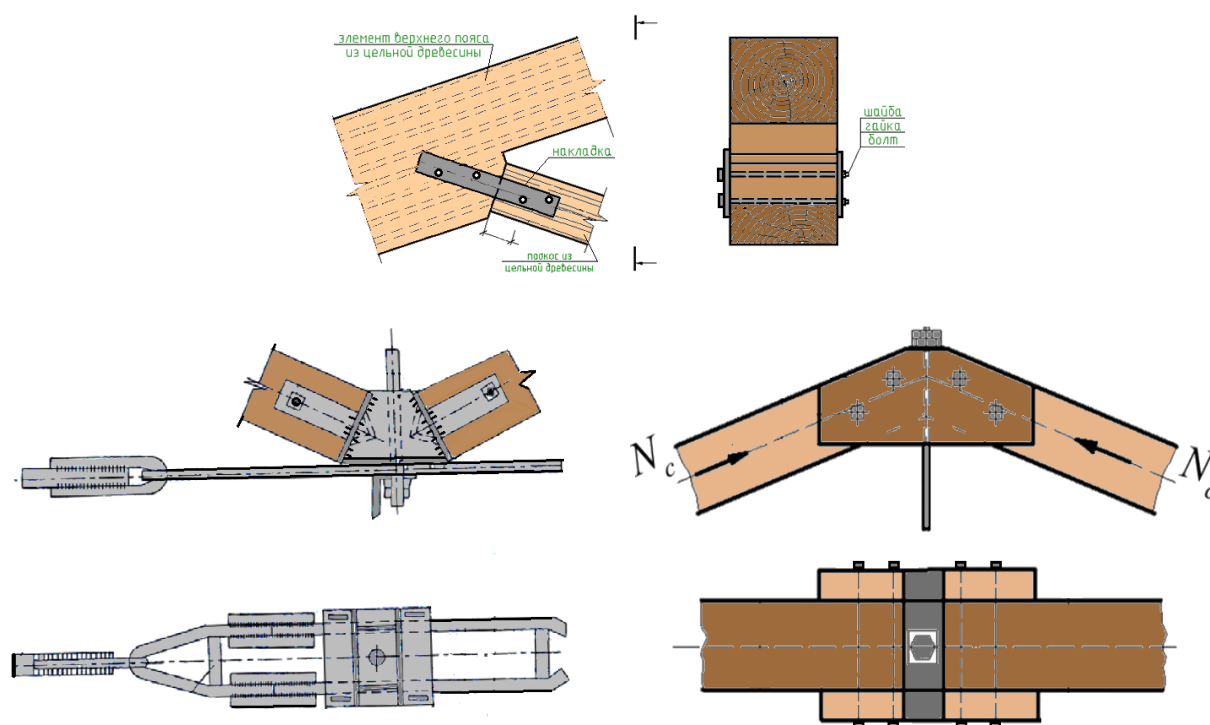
Узлы клееной треугольной фермы с неразрезным верхним поясом
